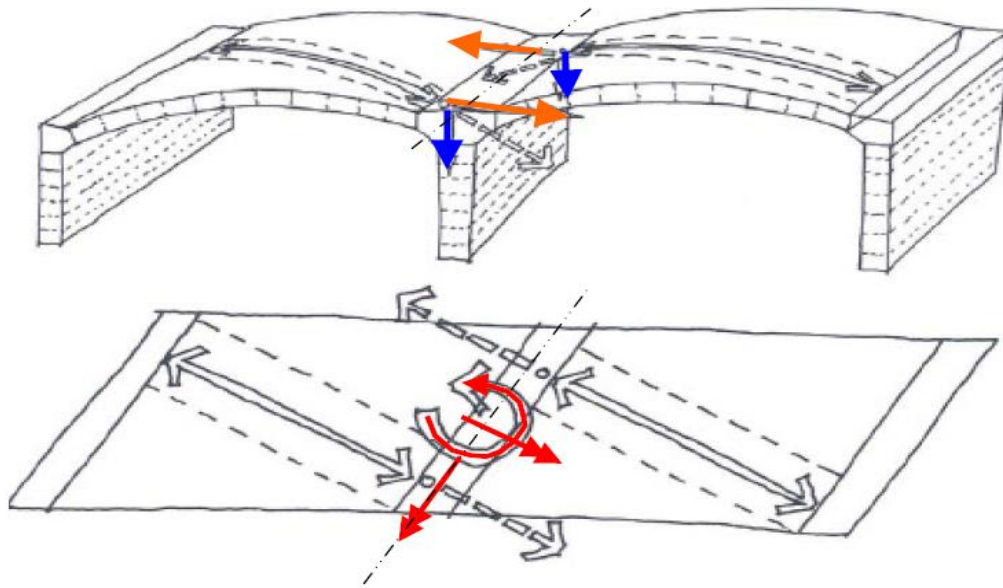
Esquema de funcionamiento de los puentes esviados de mampostería
